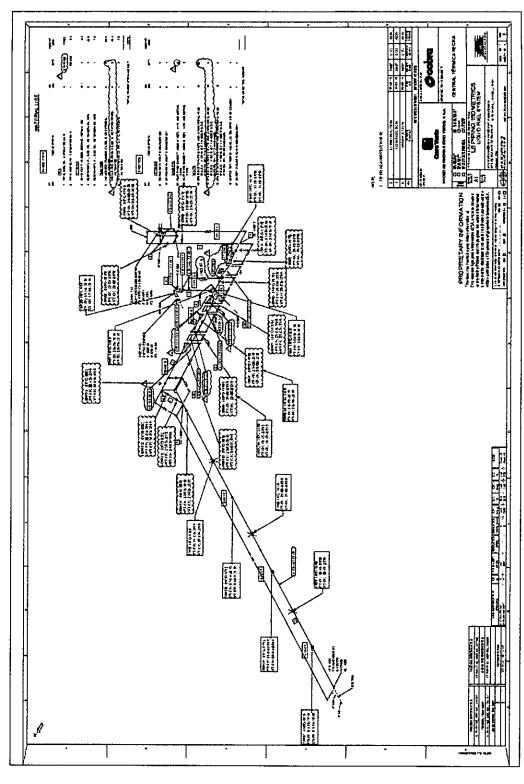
Inspección Visual de Soldadura - Soldadura de Juntas de Tuberías
